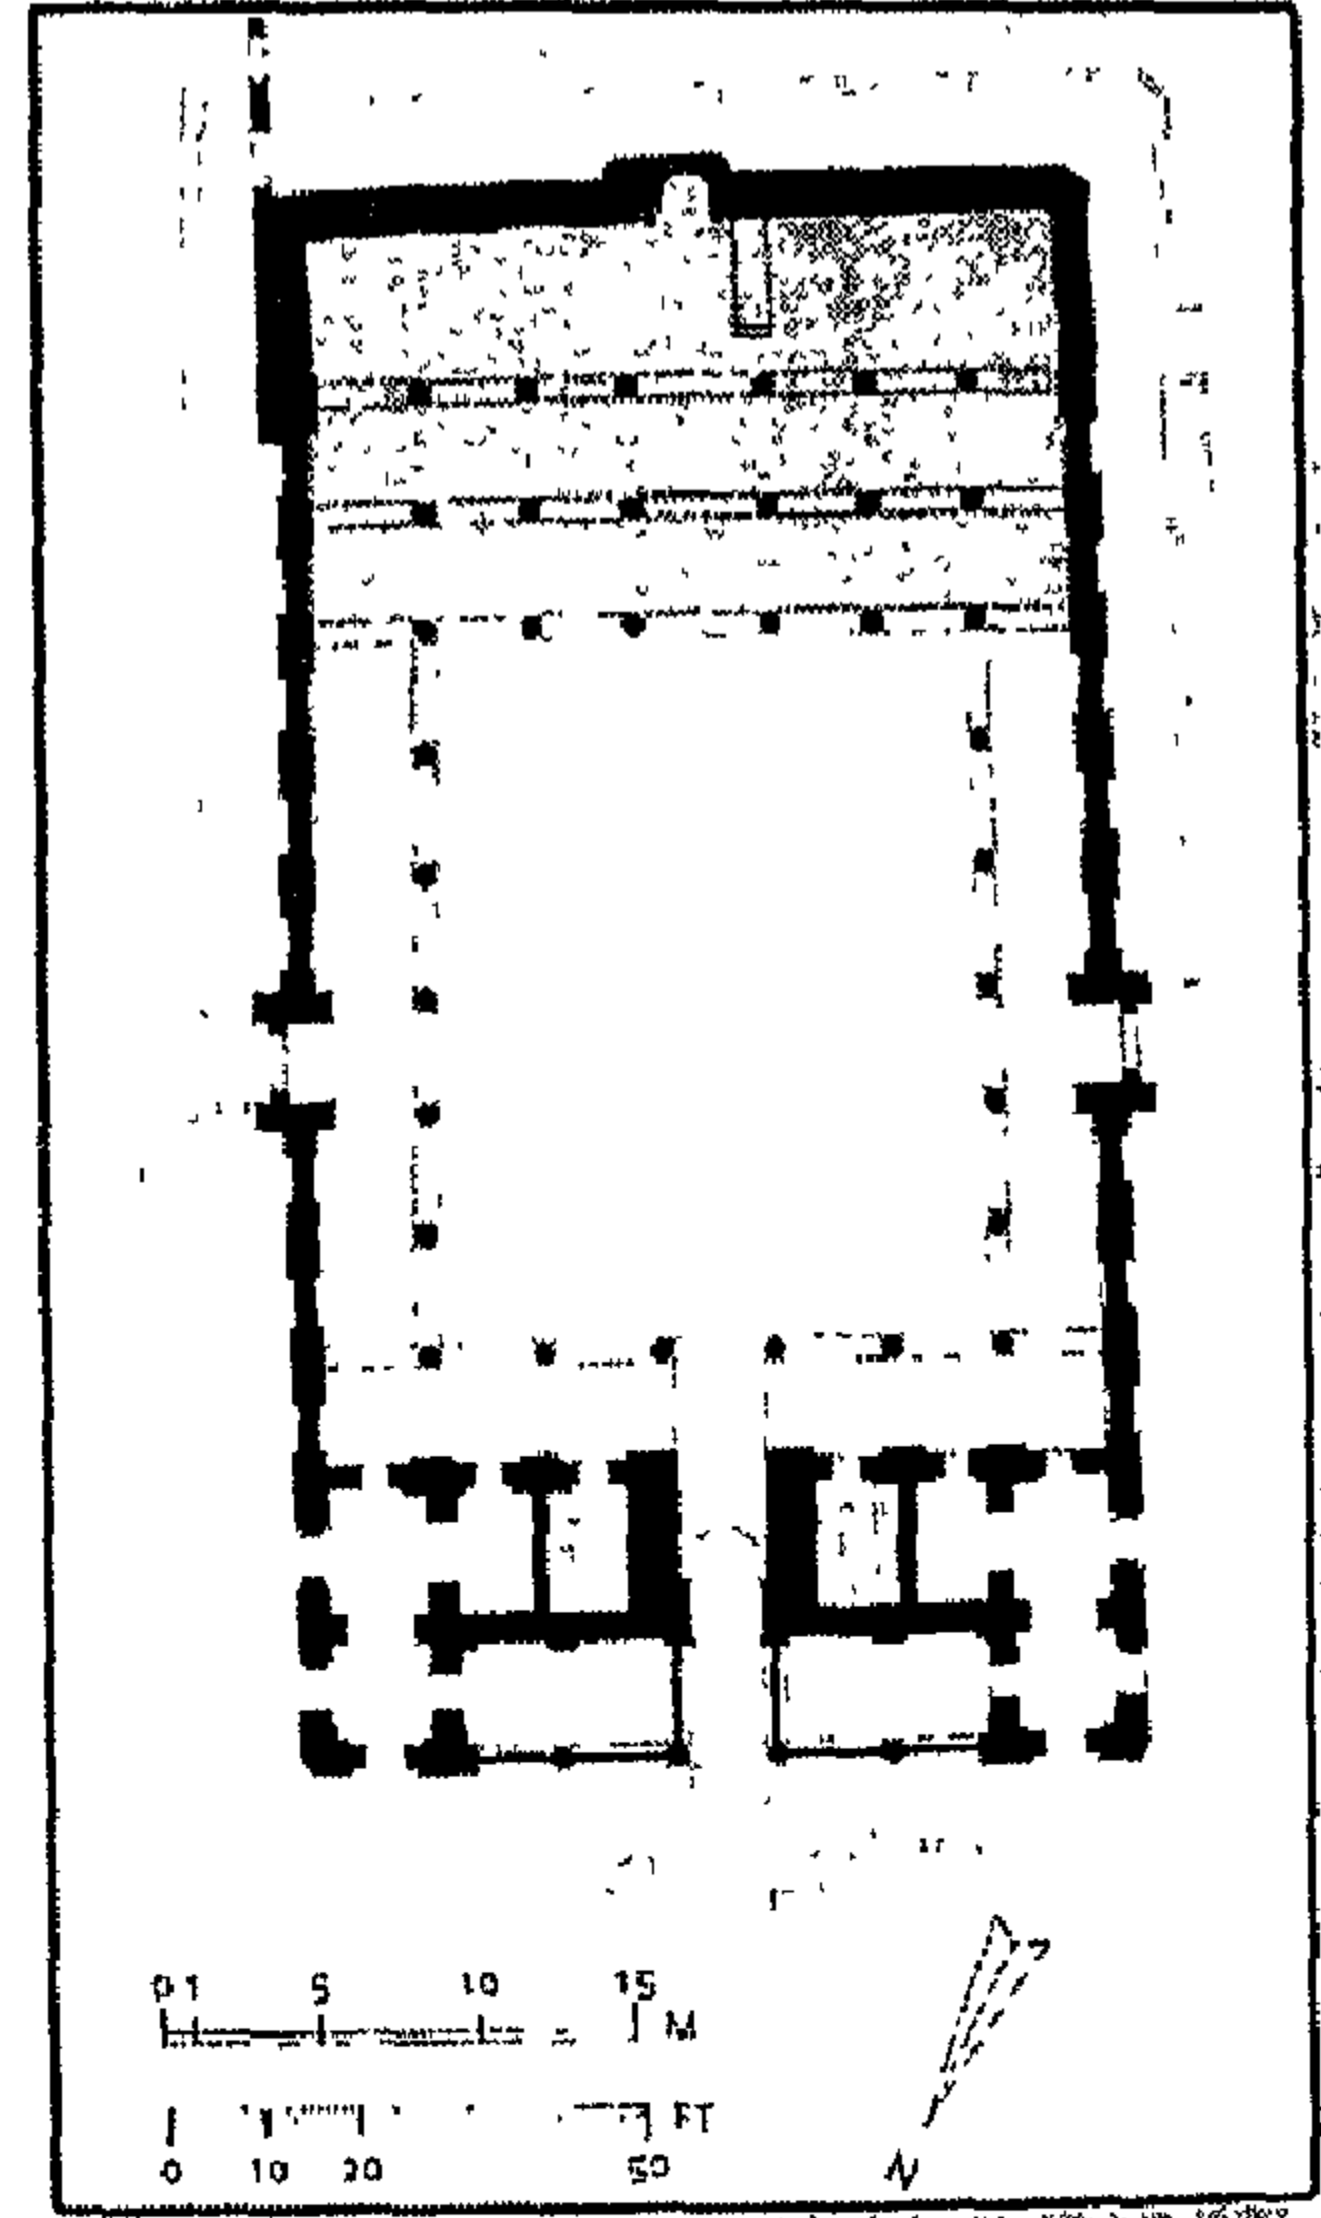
جامع الأمير أحمد بن طولون (مسقط أفقي)
